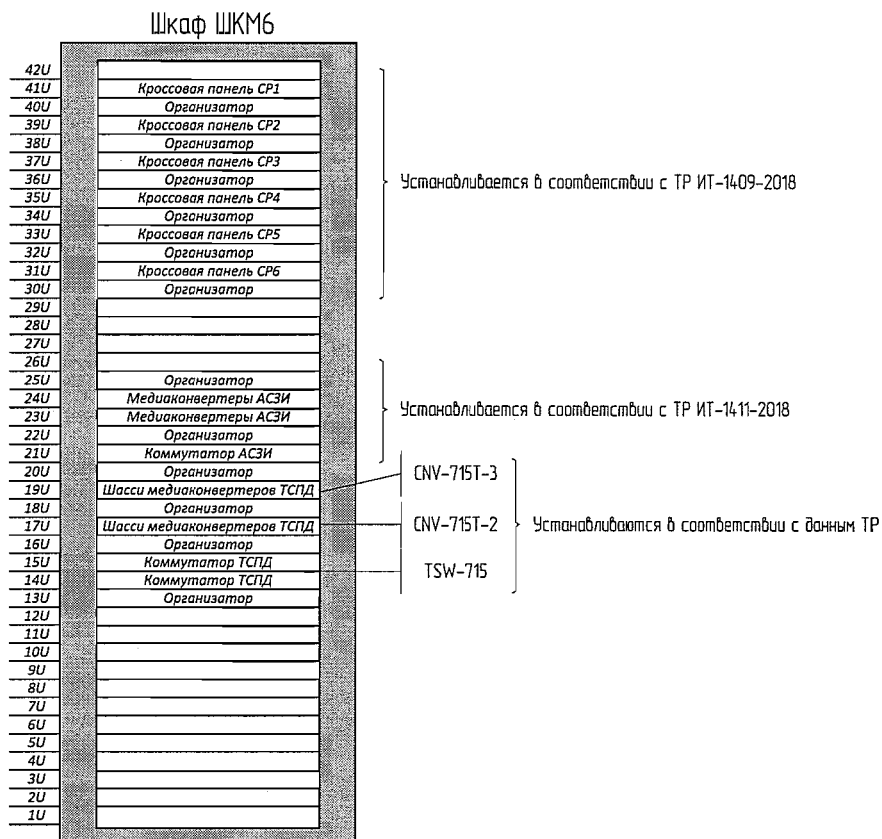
Корпус 715. Шкаф ШКМ6. Расположение оборудования.
